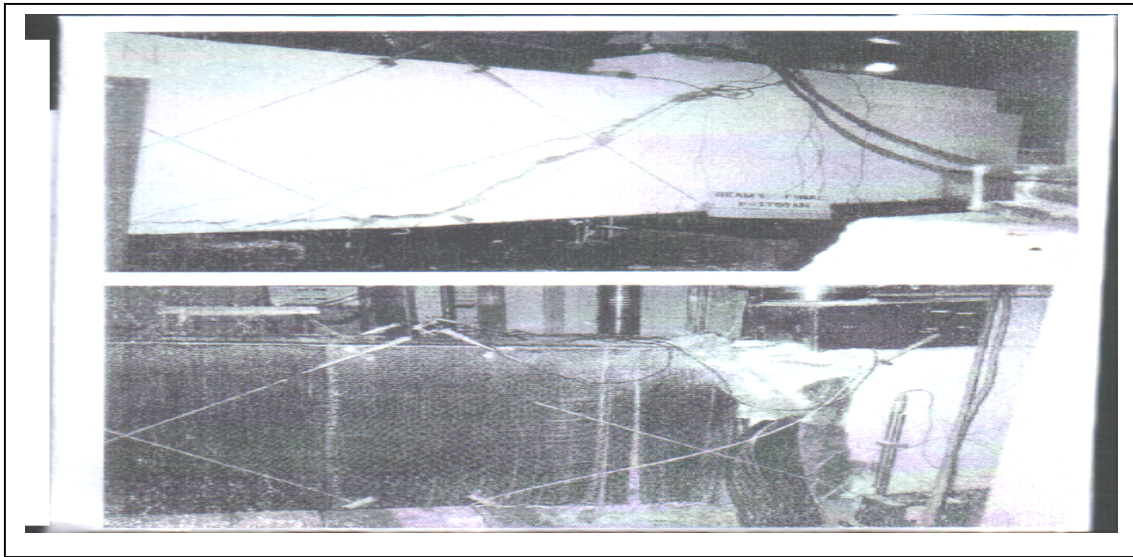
Photos de la poutre test réparée et renforcée [56]
